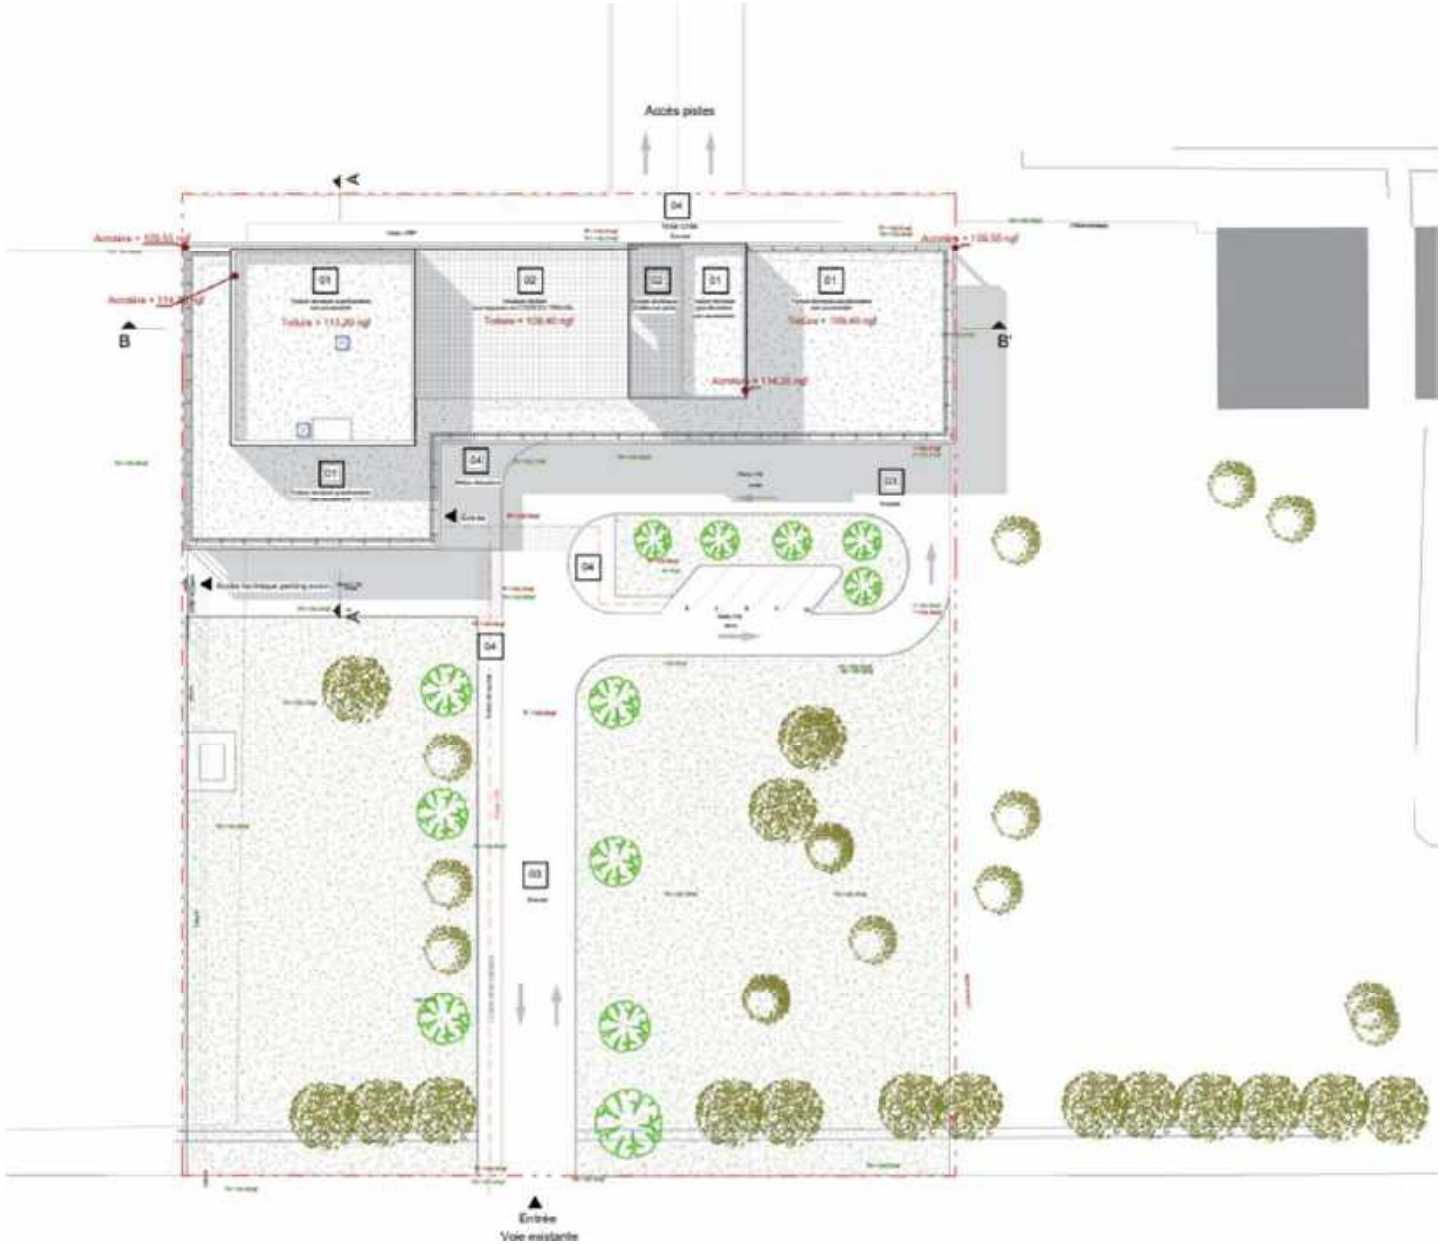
Plans du bâtiment du programme mixte (Source : PC)
